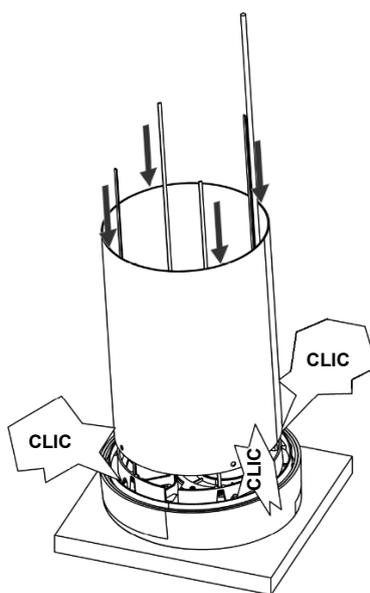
Préparation du chapeau de ventilation (tube de $\varnothing 250$ mm)
